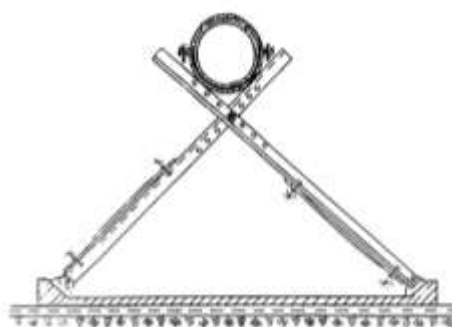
Регулируемая опора надземного трубопровода для строительства в сложных грунтовых условиях. Патент № 41829
